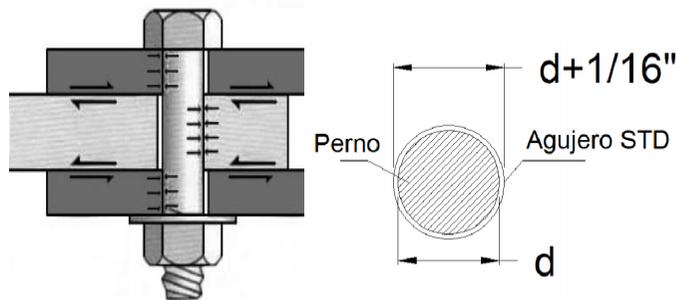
En la imagen se observa el sobre-ancho existente entre el diámetro de perforación de las placas y el diámetro del perno de conexión.
